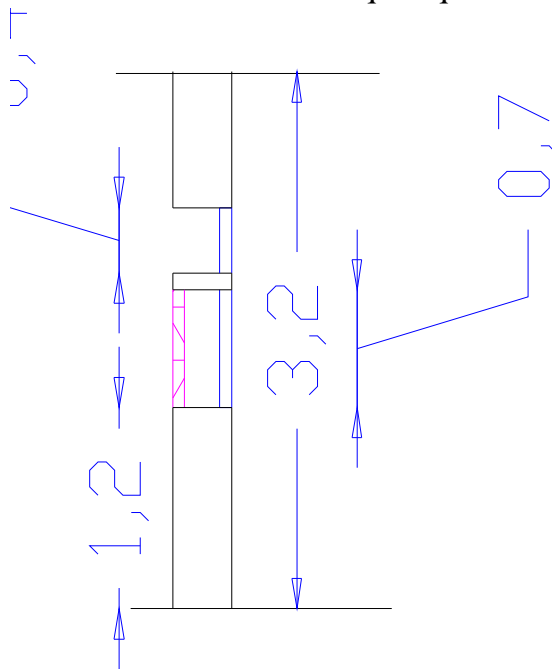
Coupe sur la fenêtre de la tour « le Yémen »
